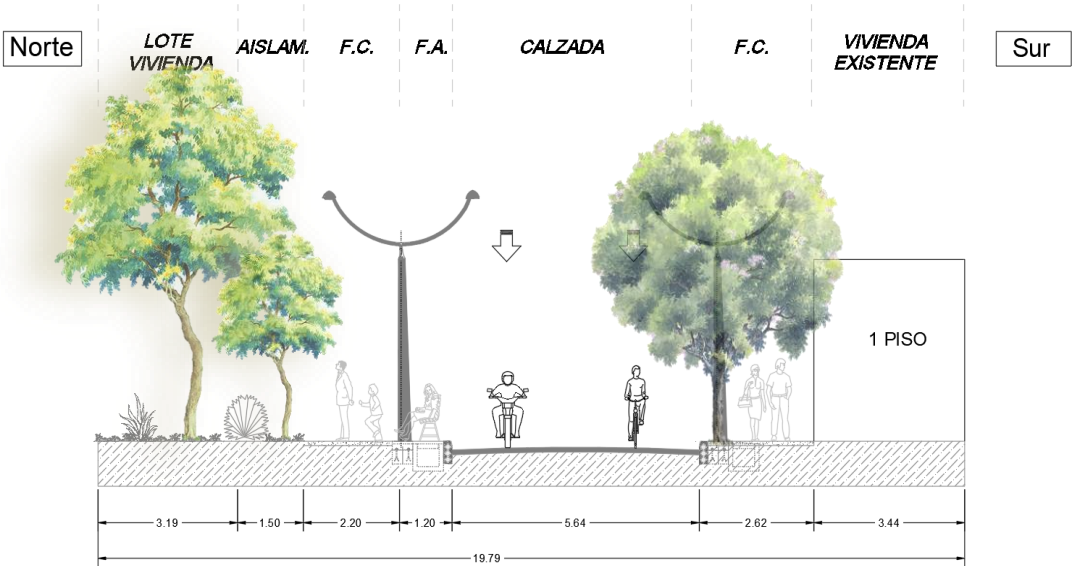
Perfil vial Calle 6, Cantagallo, Bolívar
